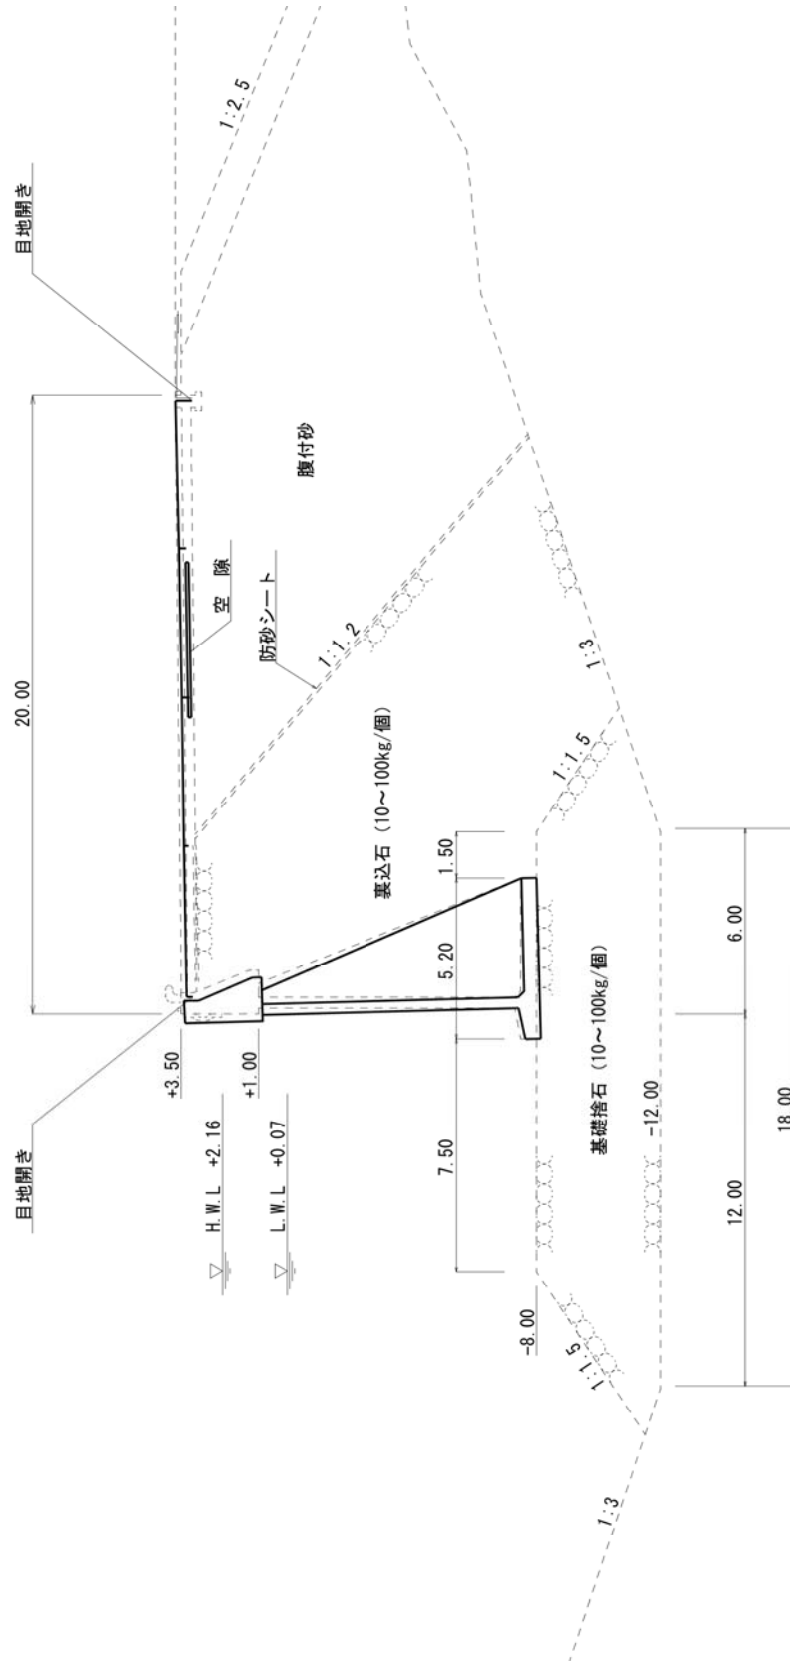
香椎パークポート地区-7.5m岸壁の被災状況断面図
